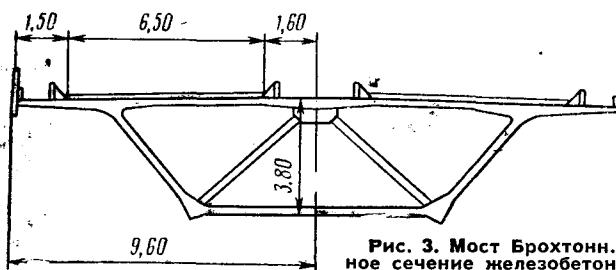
Мост Брохтонн. Поперечное сечение железобетонной предварительно напряженной коробчатой балки жесткости
